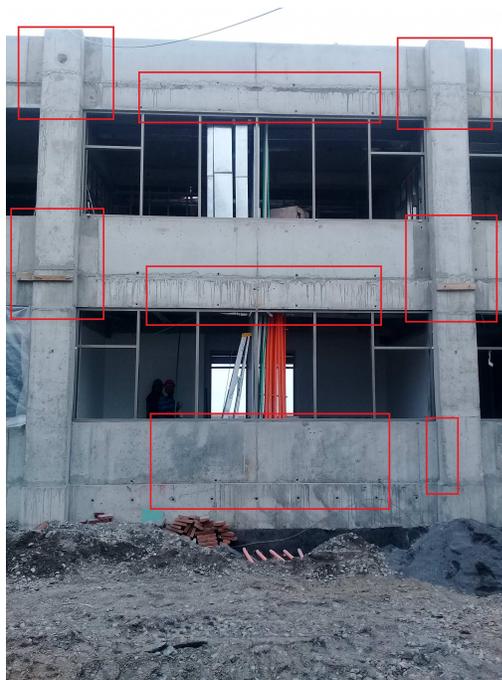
“Fachada Noroeste, entre ejes 4 y 5”
